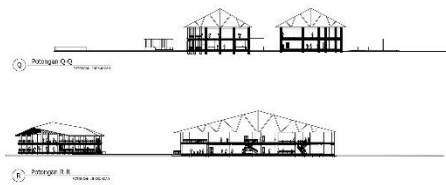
Tampak Fasilitas Batik & Galeri Workshop
